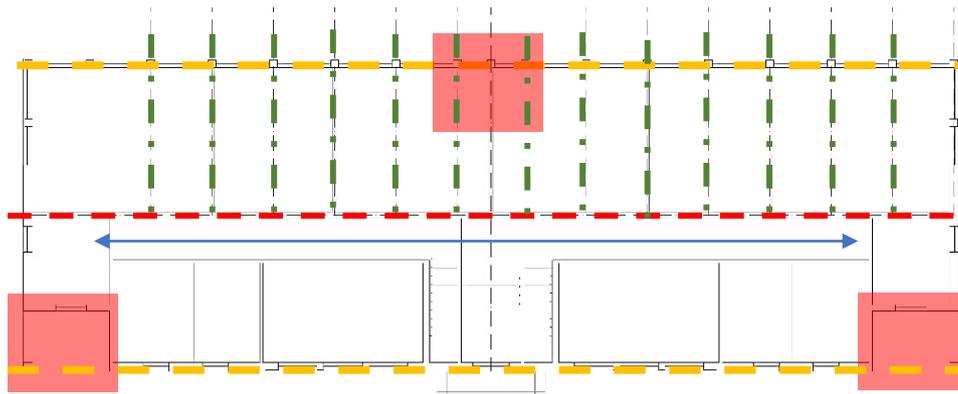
Esquema de la estructura del pabellón de Menores, de planta baja.
